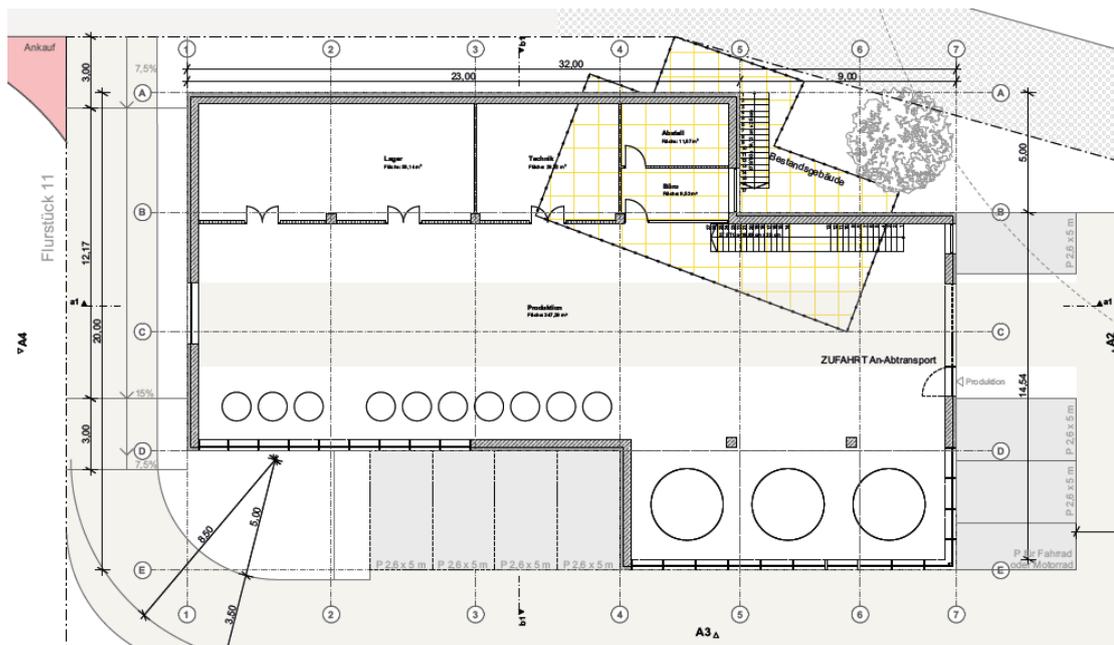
Grundriss EG (Schaack + Schank Architekten, Stand: 08.05.2023)
